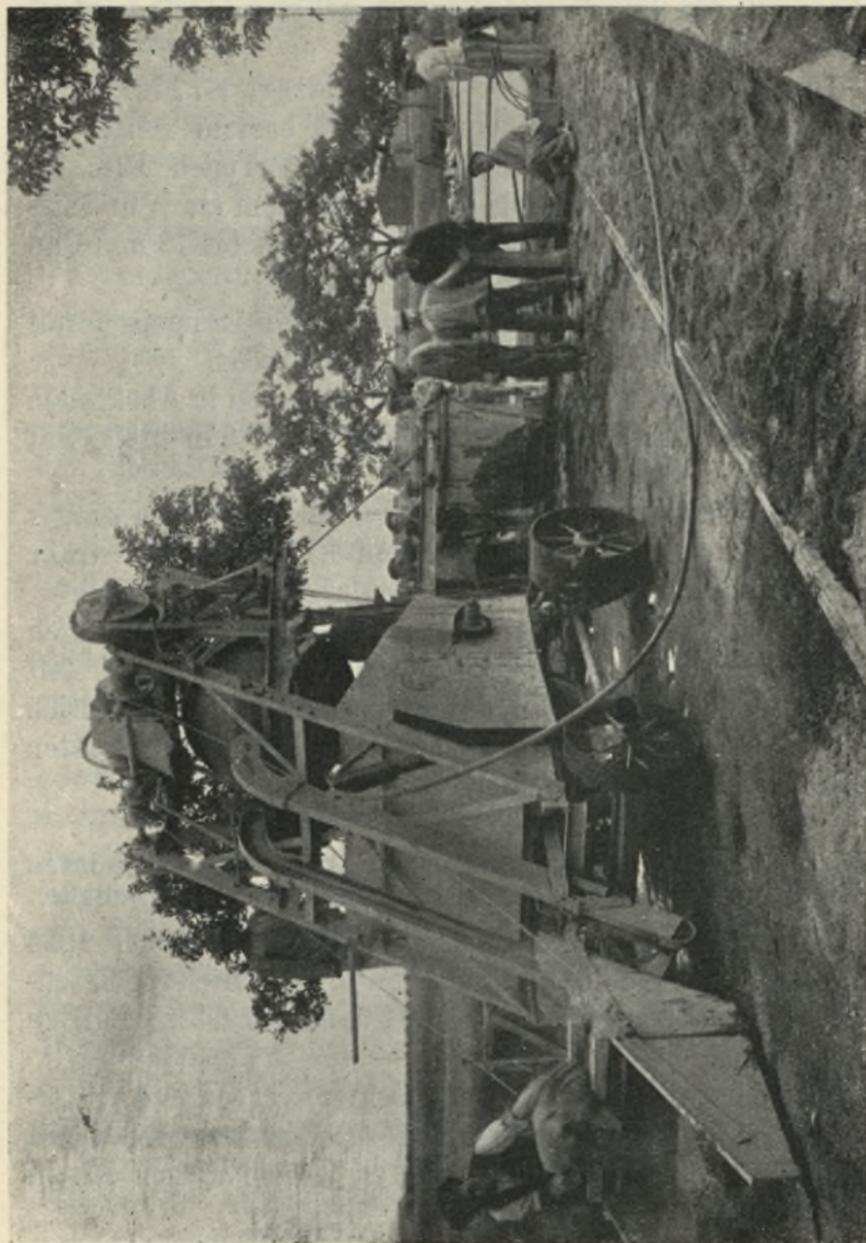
Betonversuchsstraße Groß-Salze-Felgeleben (1926). Mischen und Einbringen des Betons.
